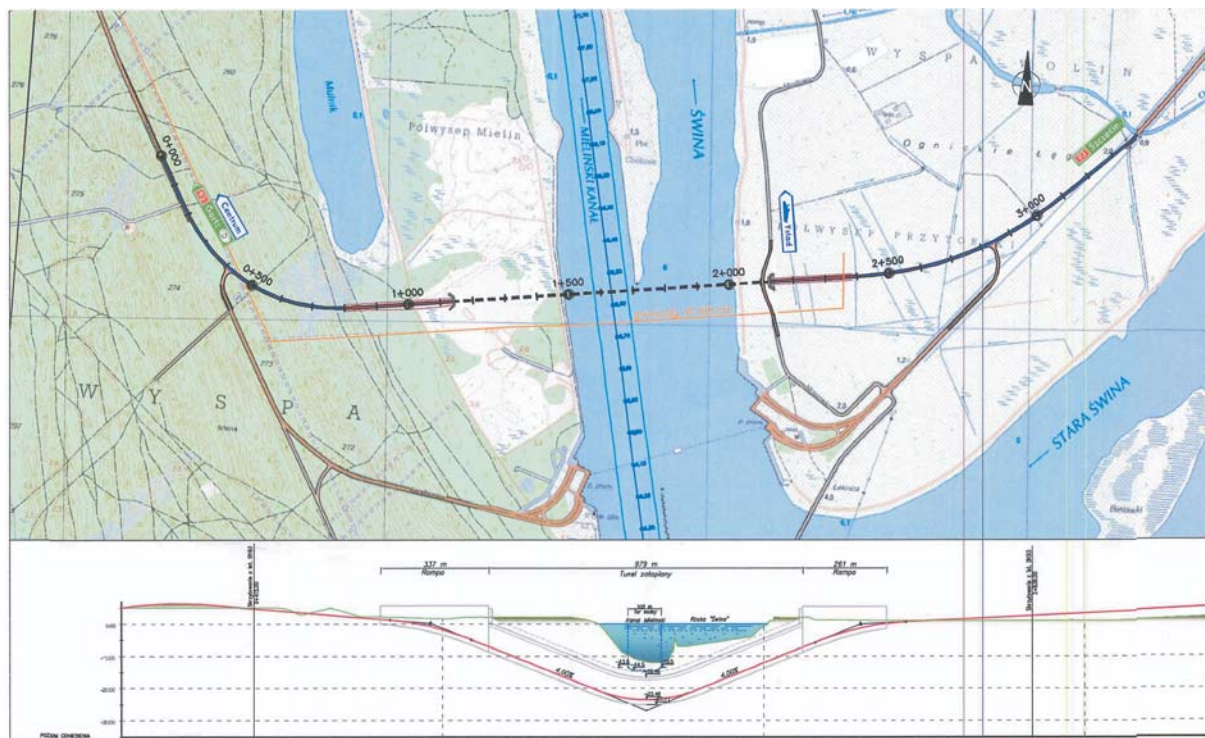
Planowany przebieg tunelu zgodnie z wariantem K3W1 (DAMART s.c., 2008)
